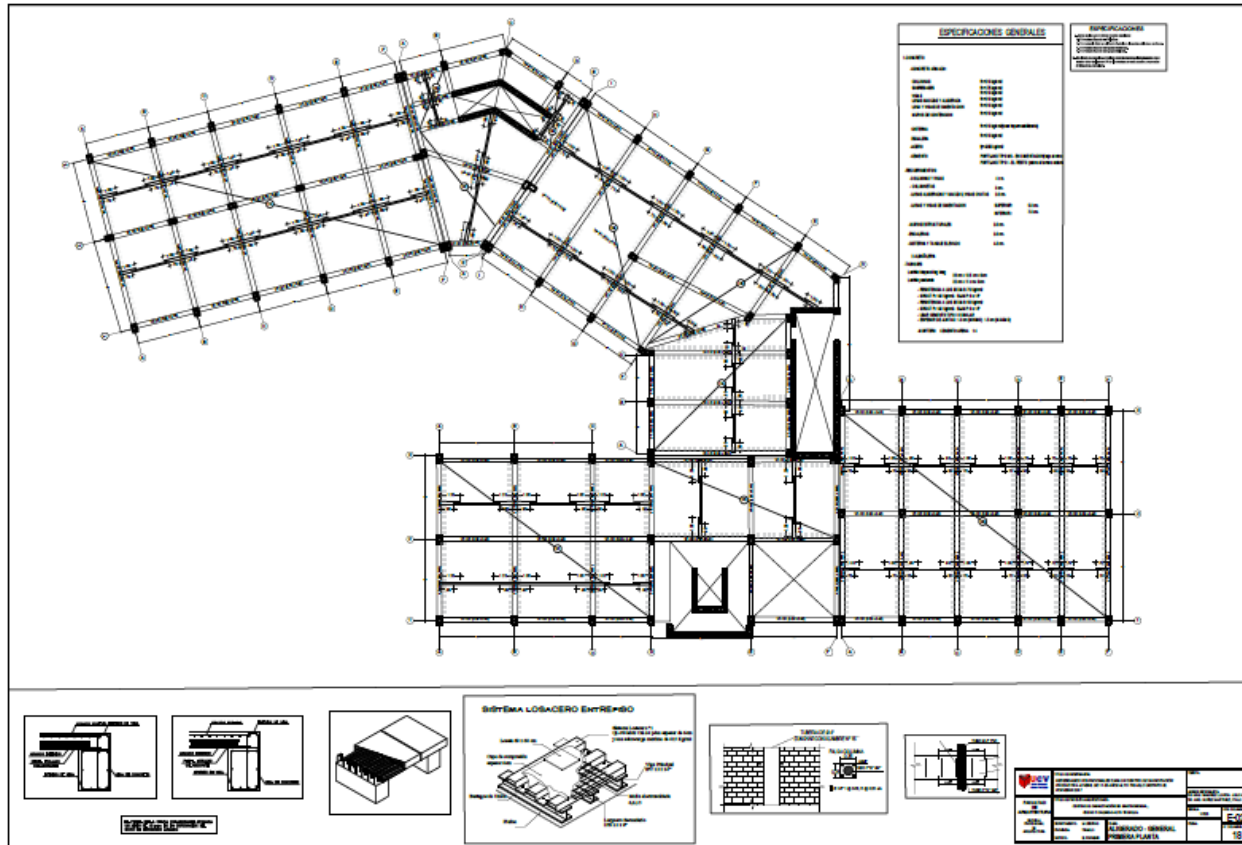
Plano de Aligerado primer nivel-Plano N°18-Lámina E02
